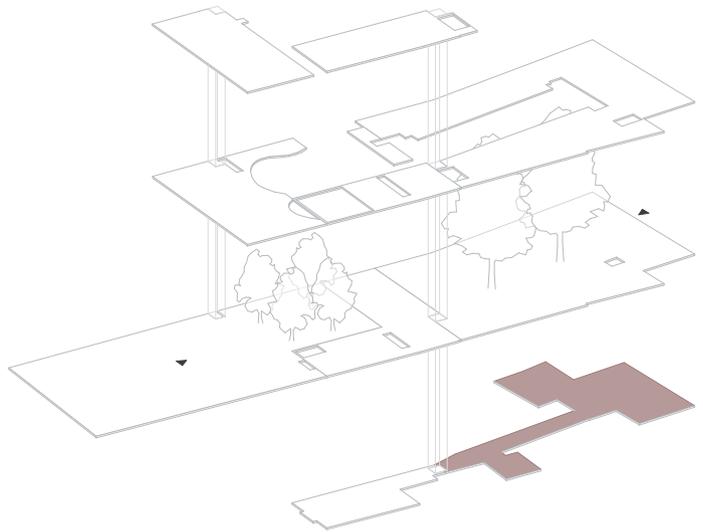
| Grundriss Kellergeschoß. Vinothek & Teile Gemüsekeller
